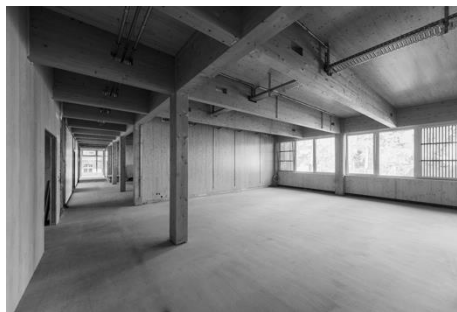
Werkhalle EG, Rohbau nach Fertigstellung
